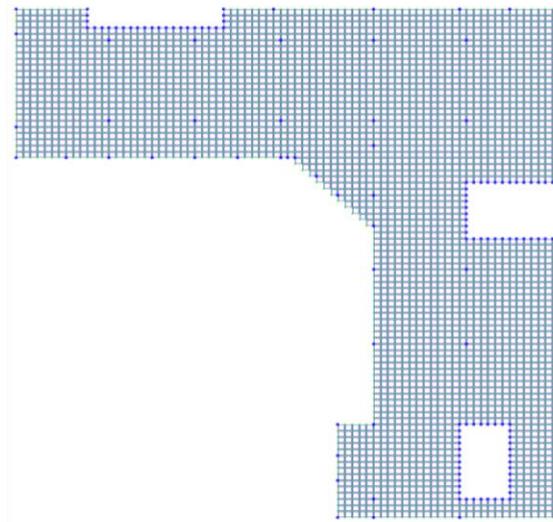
Расчётная модель монолитной плиты перекрытия
